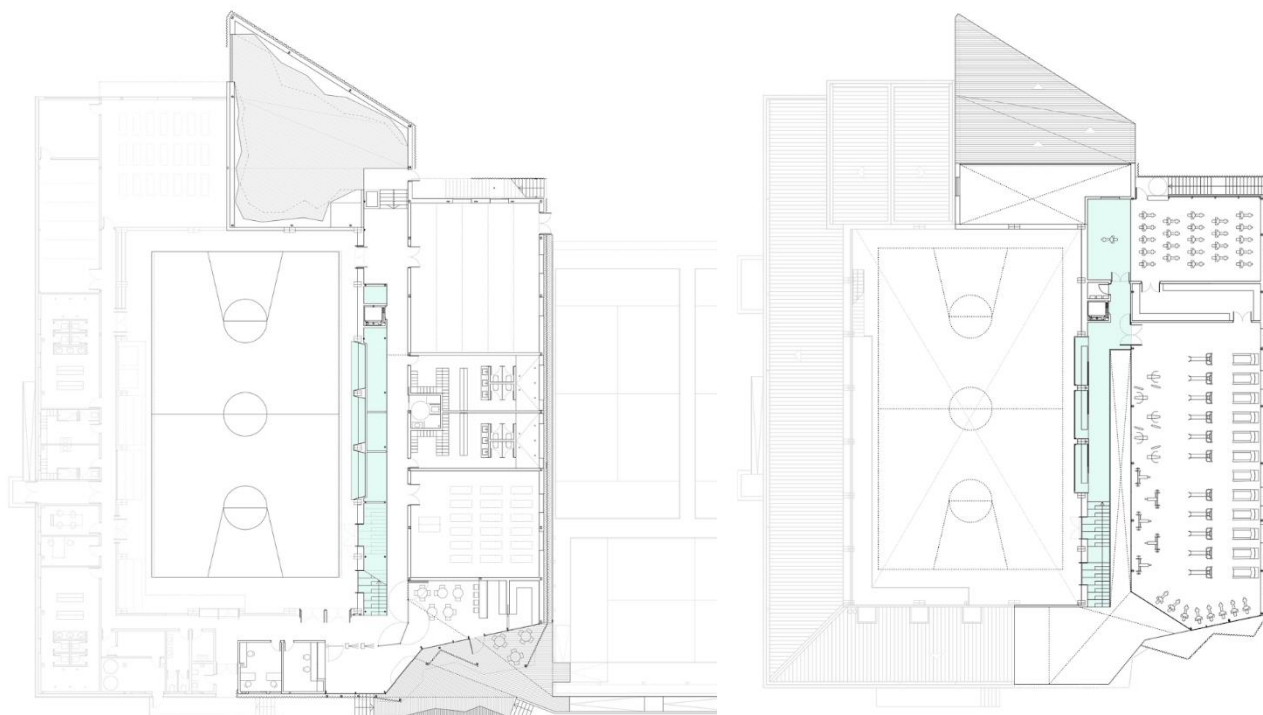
План першого та другого поверхів Las Eras [21]
